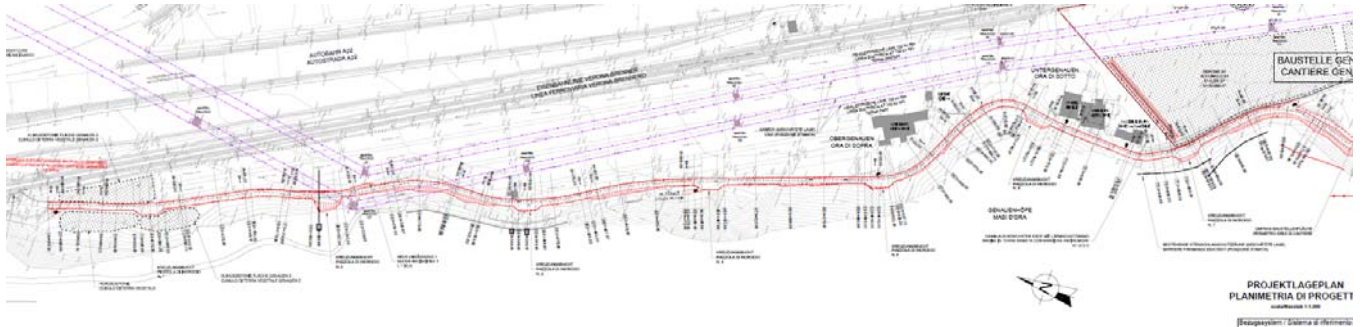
Lageplan Zufahrtstrasse Baustelle Genauen 2
